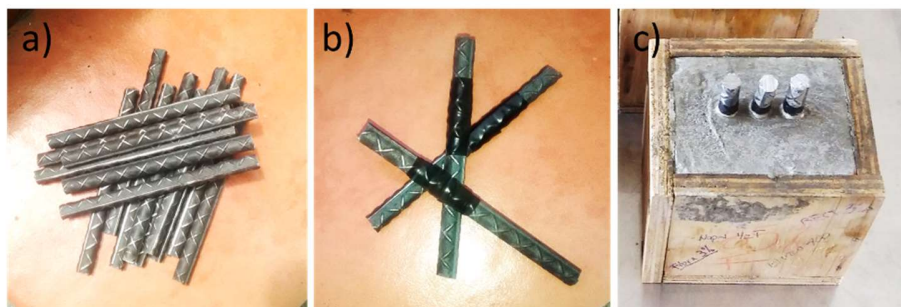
12. a) Barras de acero sin tratamiento superficial, b) Barras de acero recubiertas con cinta adhesiva y c) Muestra de concreto con tres electrodos.
